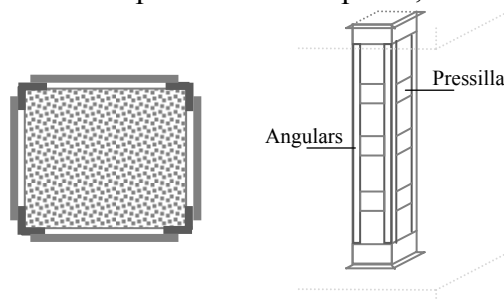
Reforç metàl·lic pilar: detall planta reforçada i pilar en perspectiva on s'aprecien els elements emprats.
